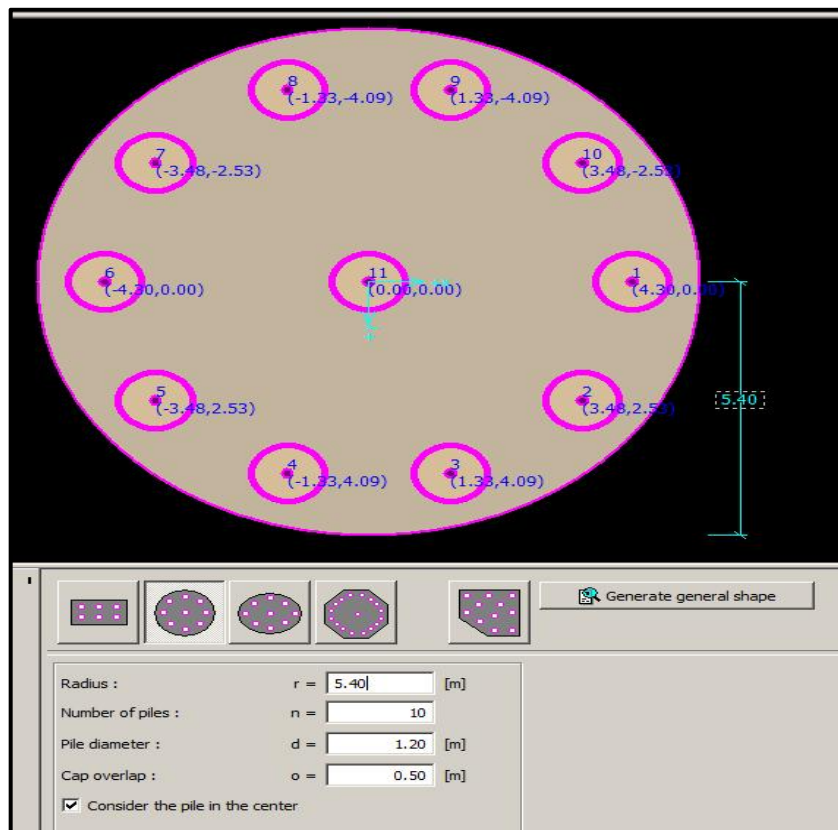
Disposition des pieux de la tour 5 (GEO5 pile groupe).
